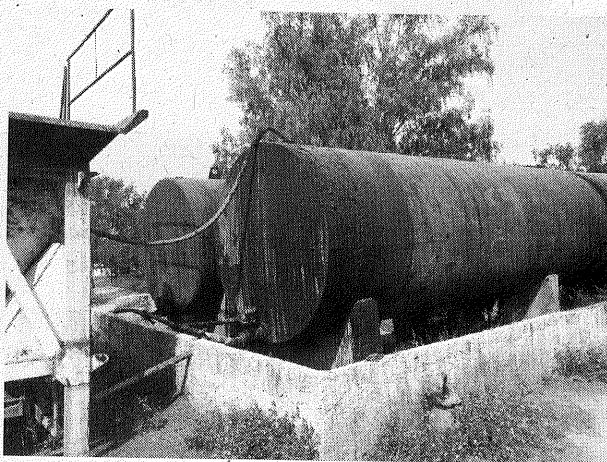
Bacia de contenção dos tanques de emulsão asfáltica perfurada por encanamento.
